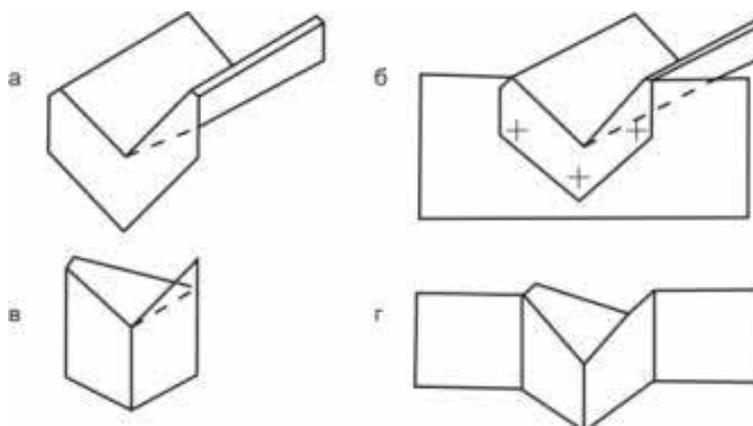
Оголовки борозд: а- пластмассовый; б- пластмассовый с закрывками; в- из жести; г- из жести с закрывками
